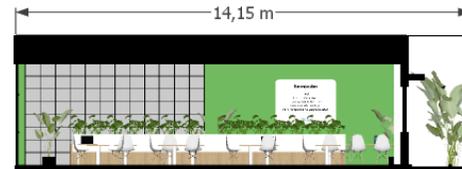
Detail ruang belajar (Hasil Rancangan, 2021)
